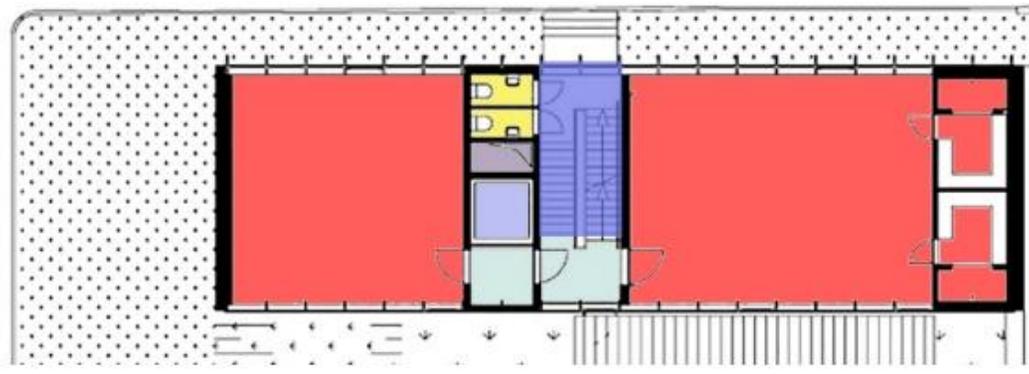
análisis planta baja, centro cultural Anndenne fuente: elaboración propia
